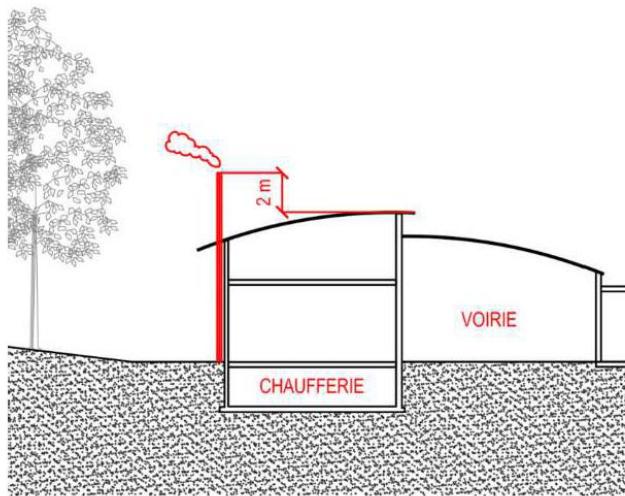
Coupe de principe du prolongement de la cheminée existante
